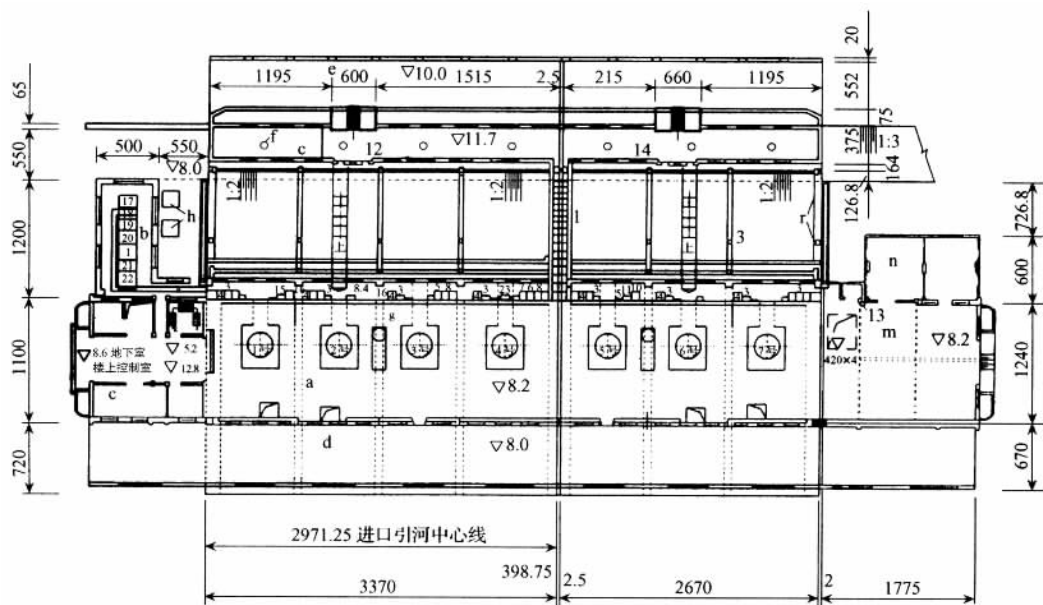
江都四站站身平面图 (尺寸单位: cm)
